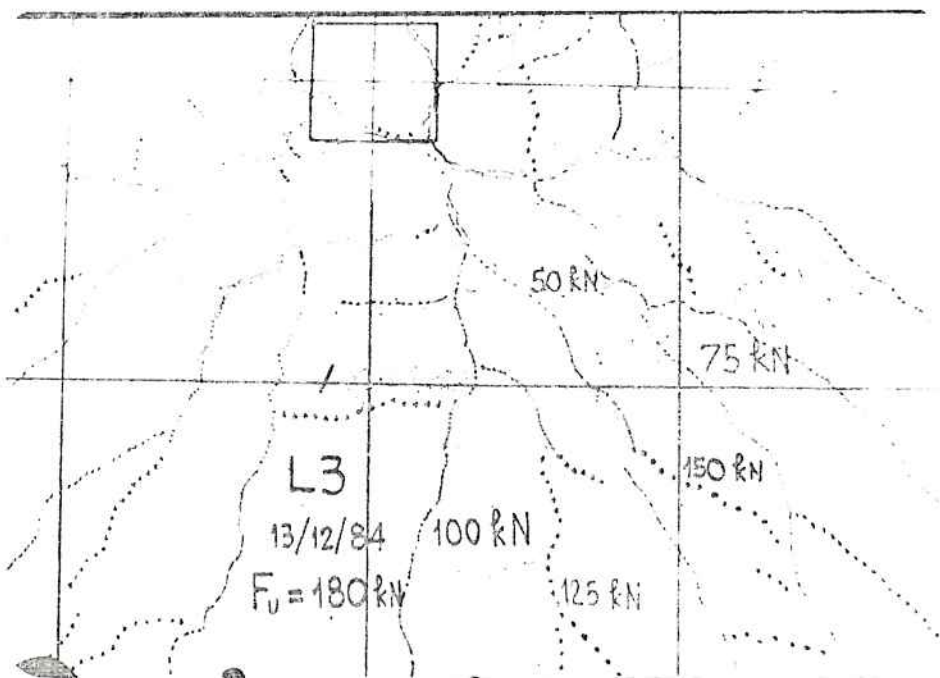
FISSURAÇÃO FINAL DA LAJE L 3
